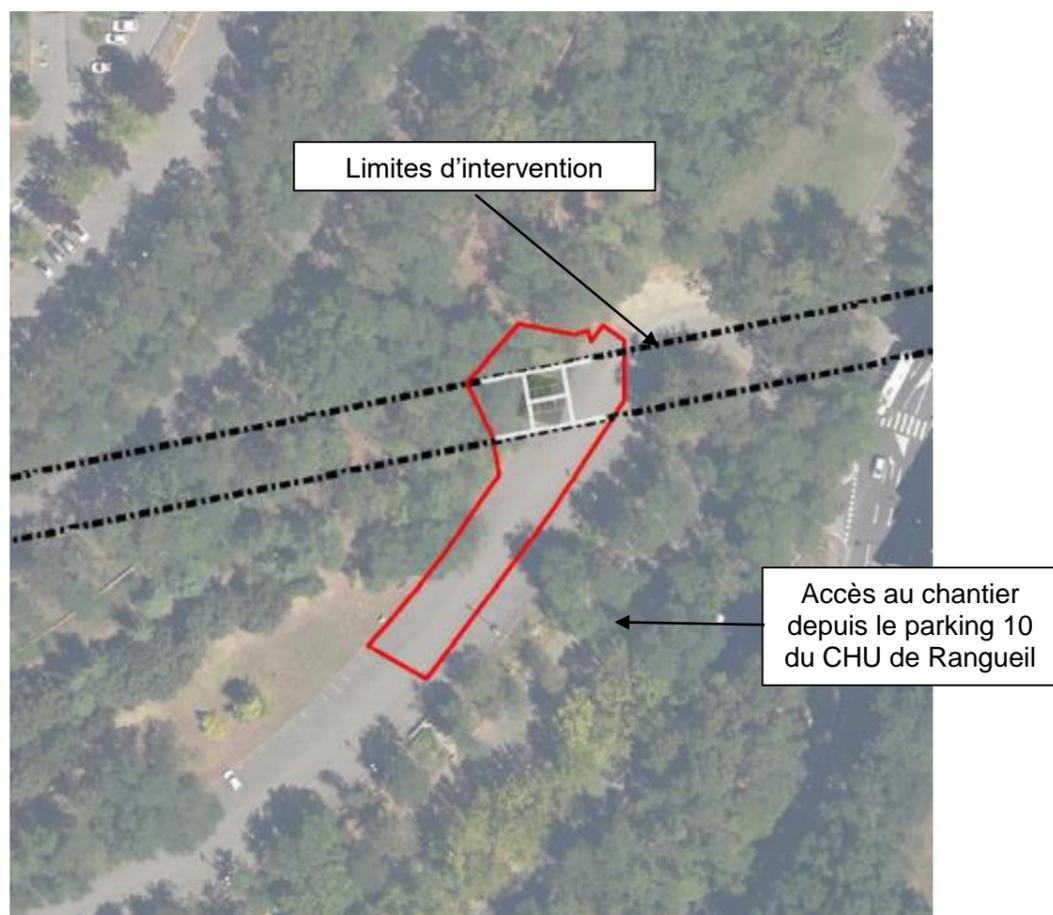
Plan de la zone travaux du pylône 4 (Source : Groupement POMA, 2018)
